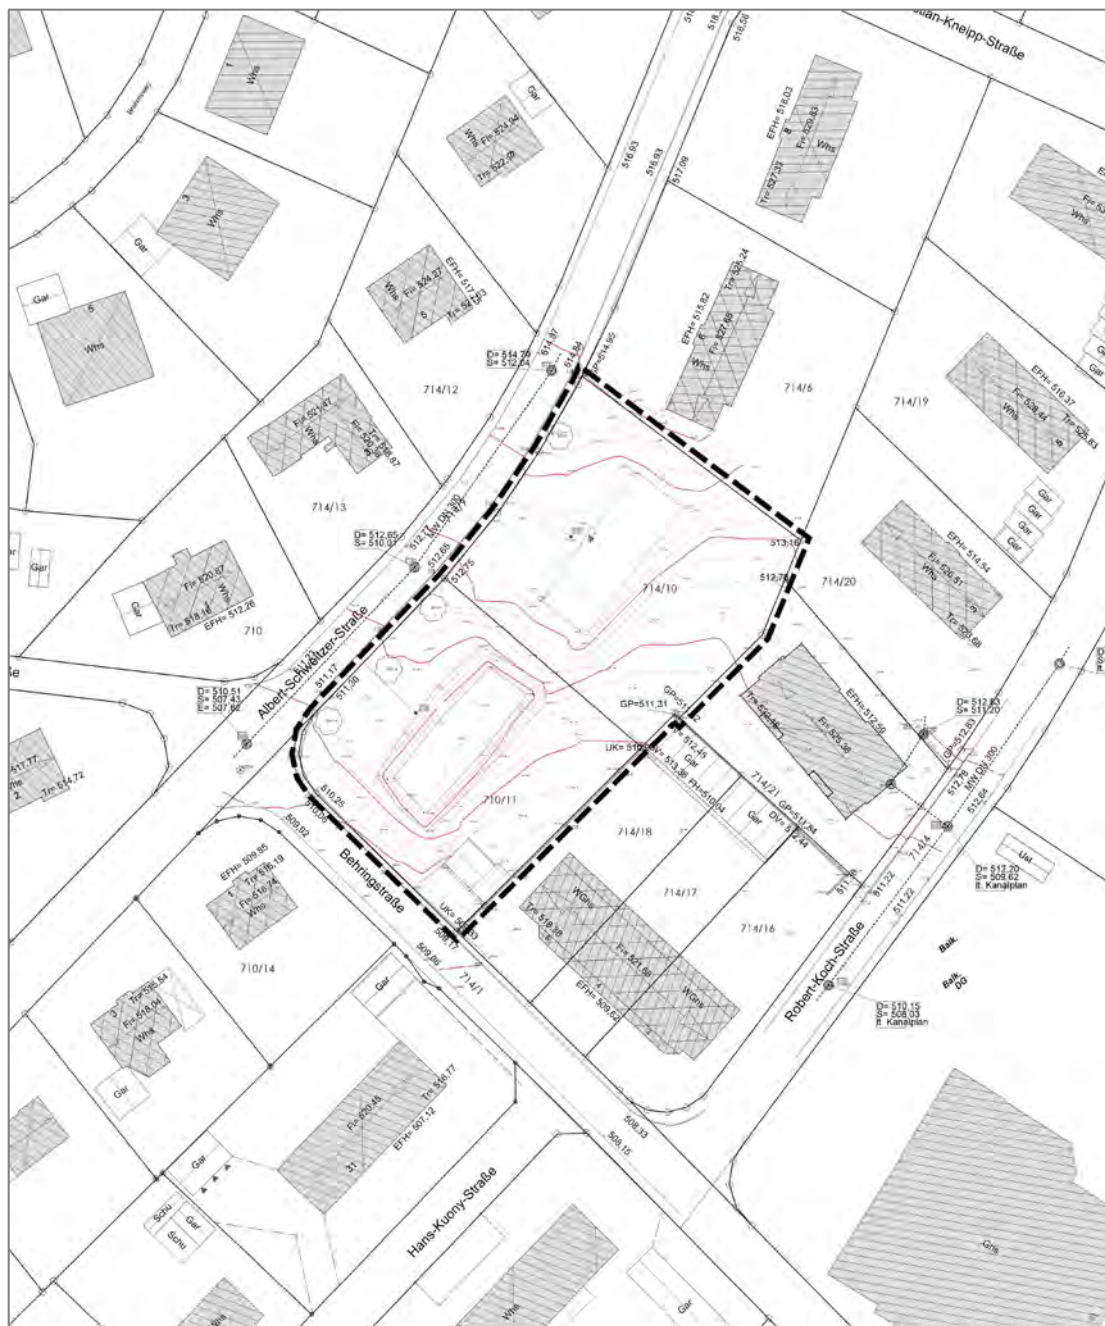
Wettbewerbsgebiet mit Höhenangaben der umgebenen Bebauung, Höhenlinien und Baumbestand. Die Bestandsgebäude sind bereits abgerissen. Quelle: Stadtbau Lörrach auf Grundlage des Katasters der Stadt Stockach. 2022.
